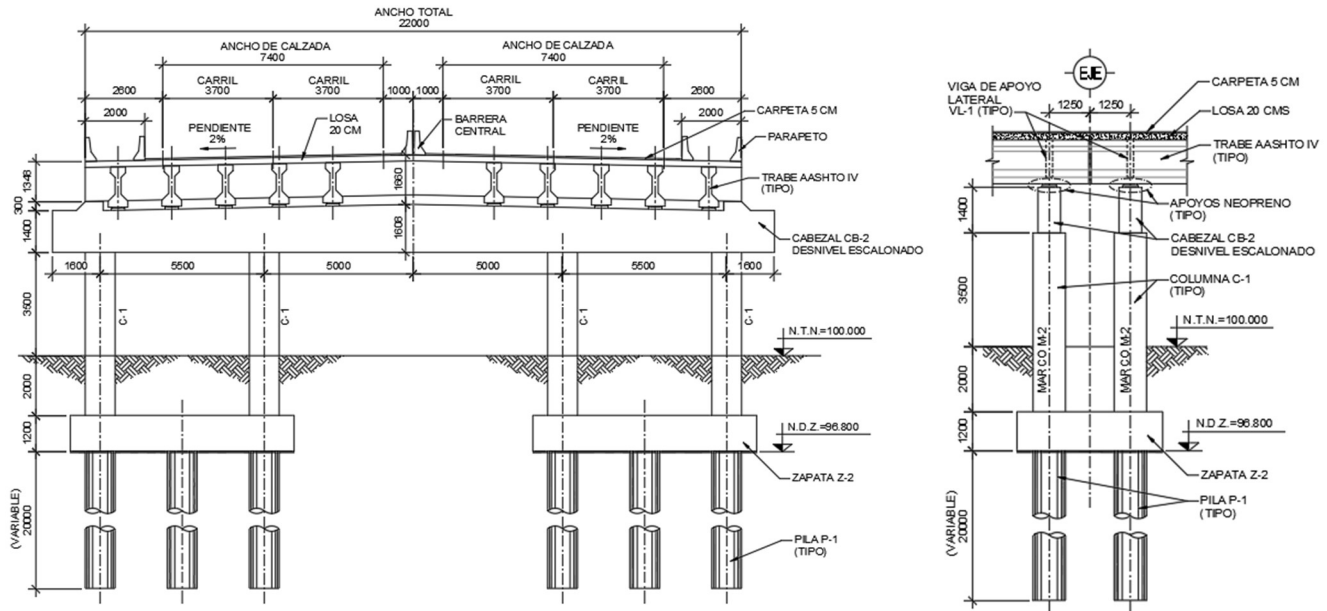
Vista lateral y frontal de los marcos dobles M-2, ejes 2-6
